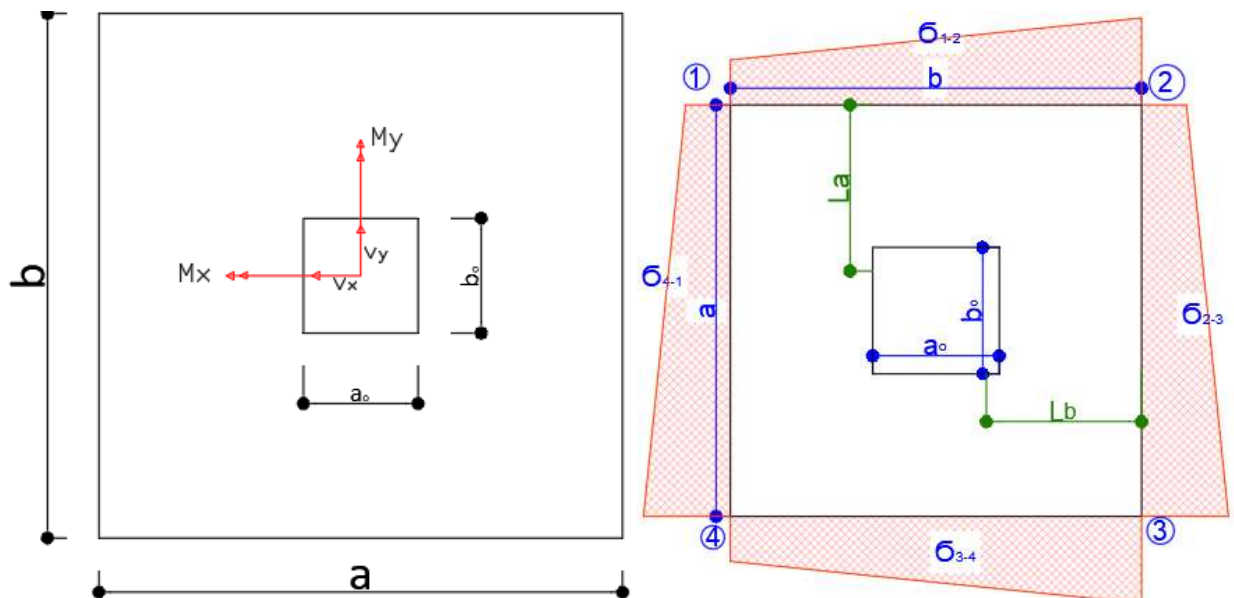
Sección de la Zapata, Fuente: Elaboración propia.
